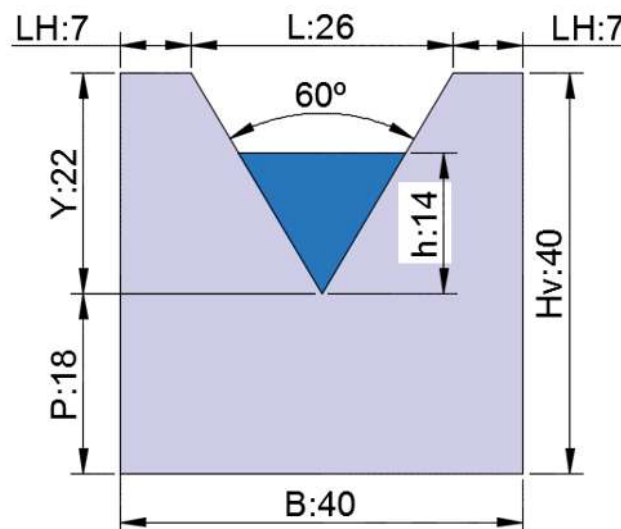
Vertedor triangular, cotas en centímetros.
